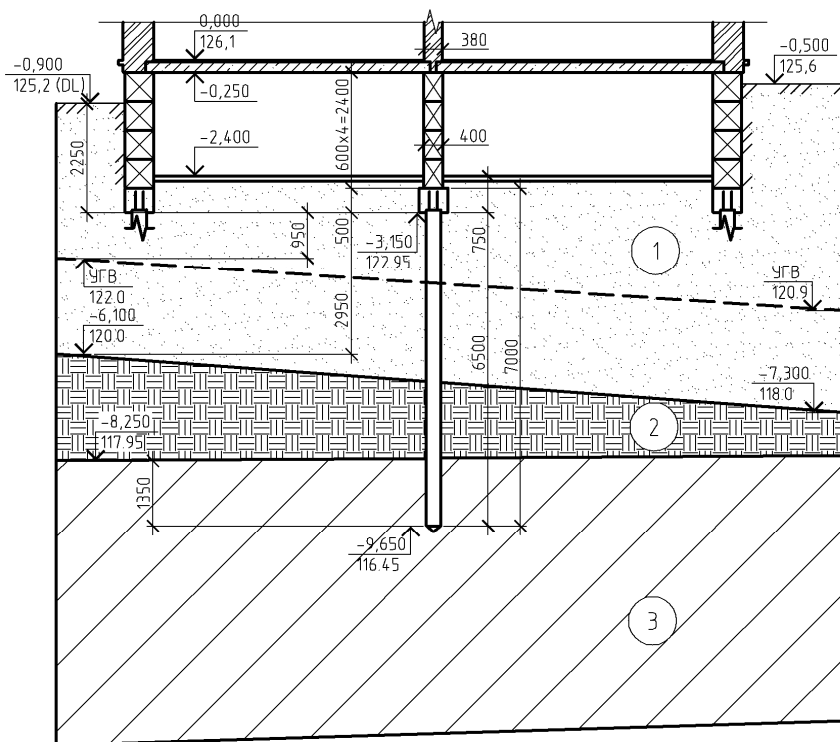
Схема к предварительному выбору свайного фундамента под несущие стены
